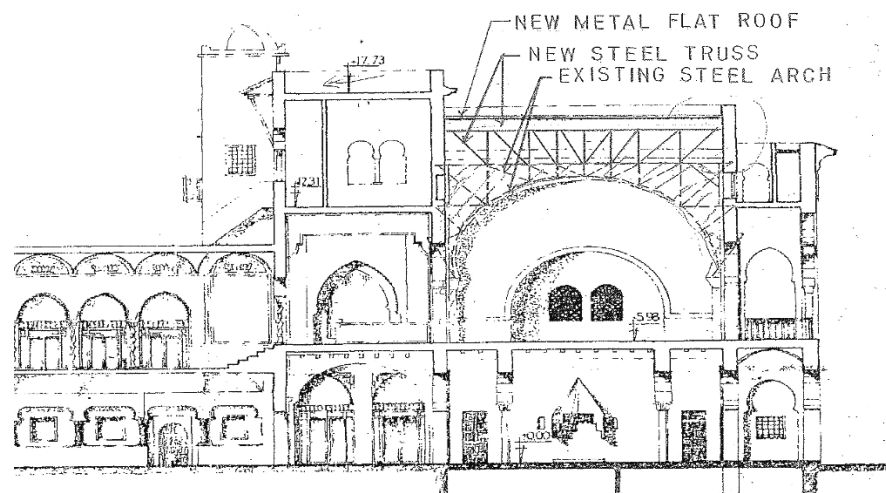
Renforcement de la toiture avec treillis d'acier supplémentaires aux arches d'acier existants
